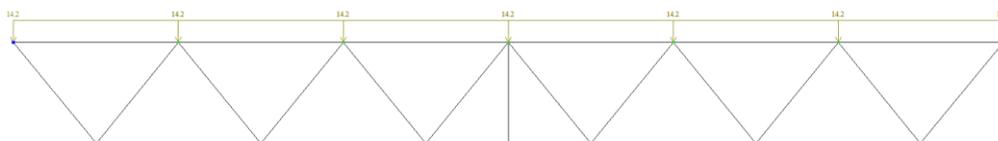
Приложение нагрузки на верхний пояс фермы от снега
